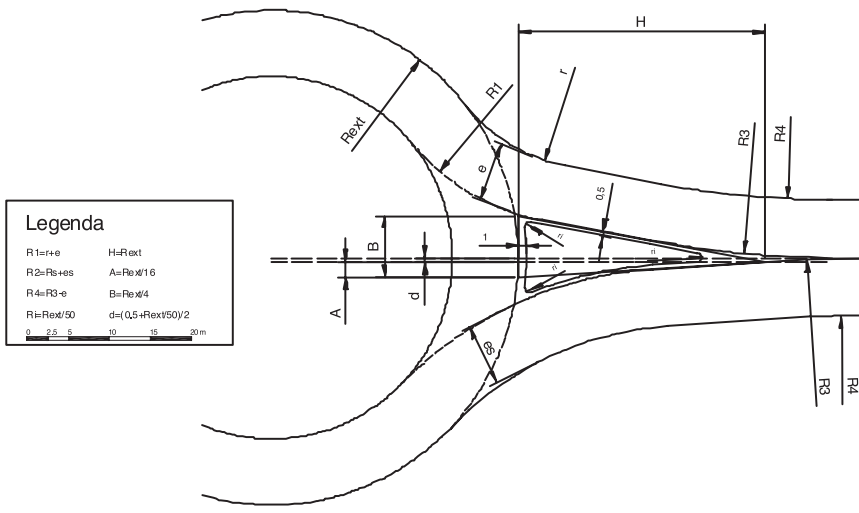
Traçado do ilhéu separador - Rotundas com raio exterior superior a 15 metros (SETRA, 1998)
